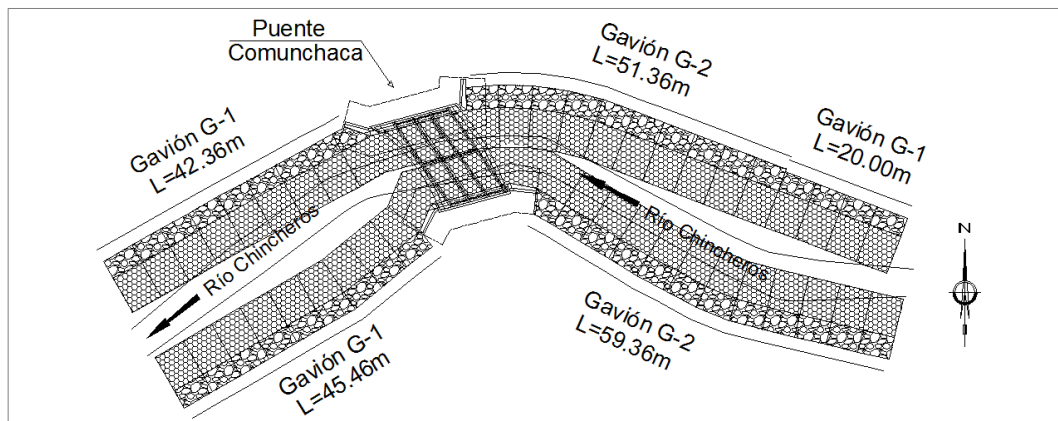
Vista en planta del puente Comunchaca y ubicación de gaviones sobre el río Chincheros.
